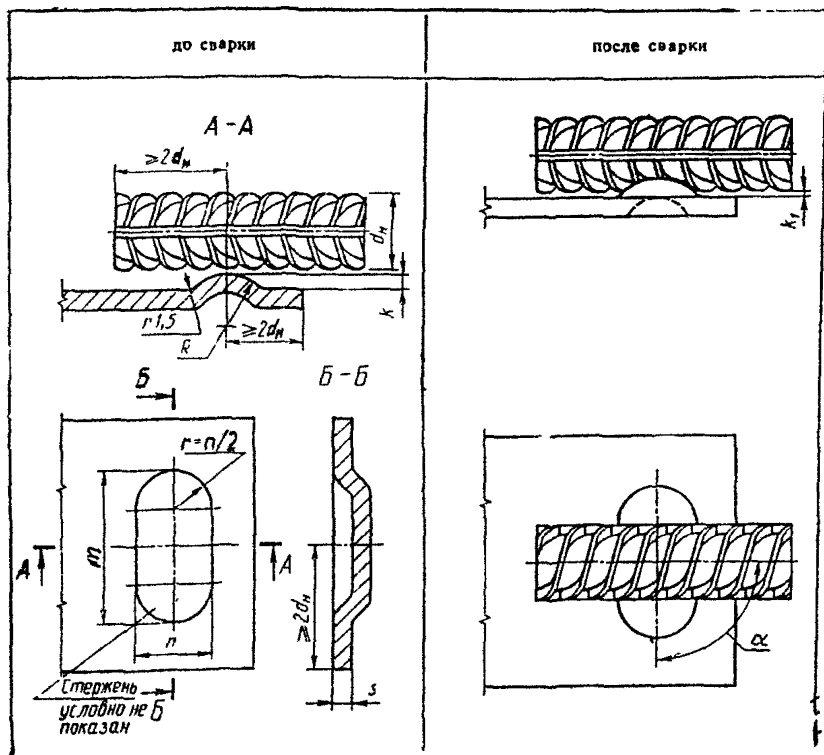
Конструкция нахлесточного соединения, выполняемого контактной рельефной сваркой по одному рельефу на пластине
